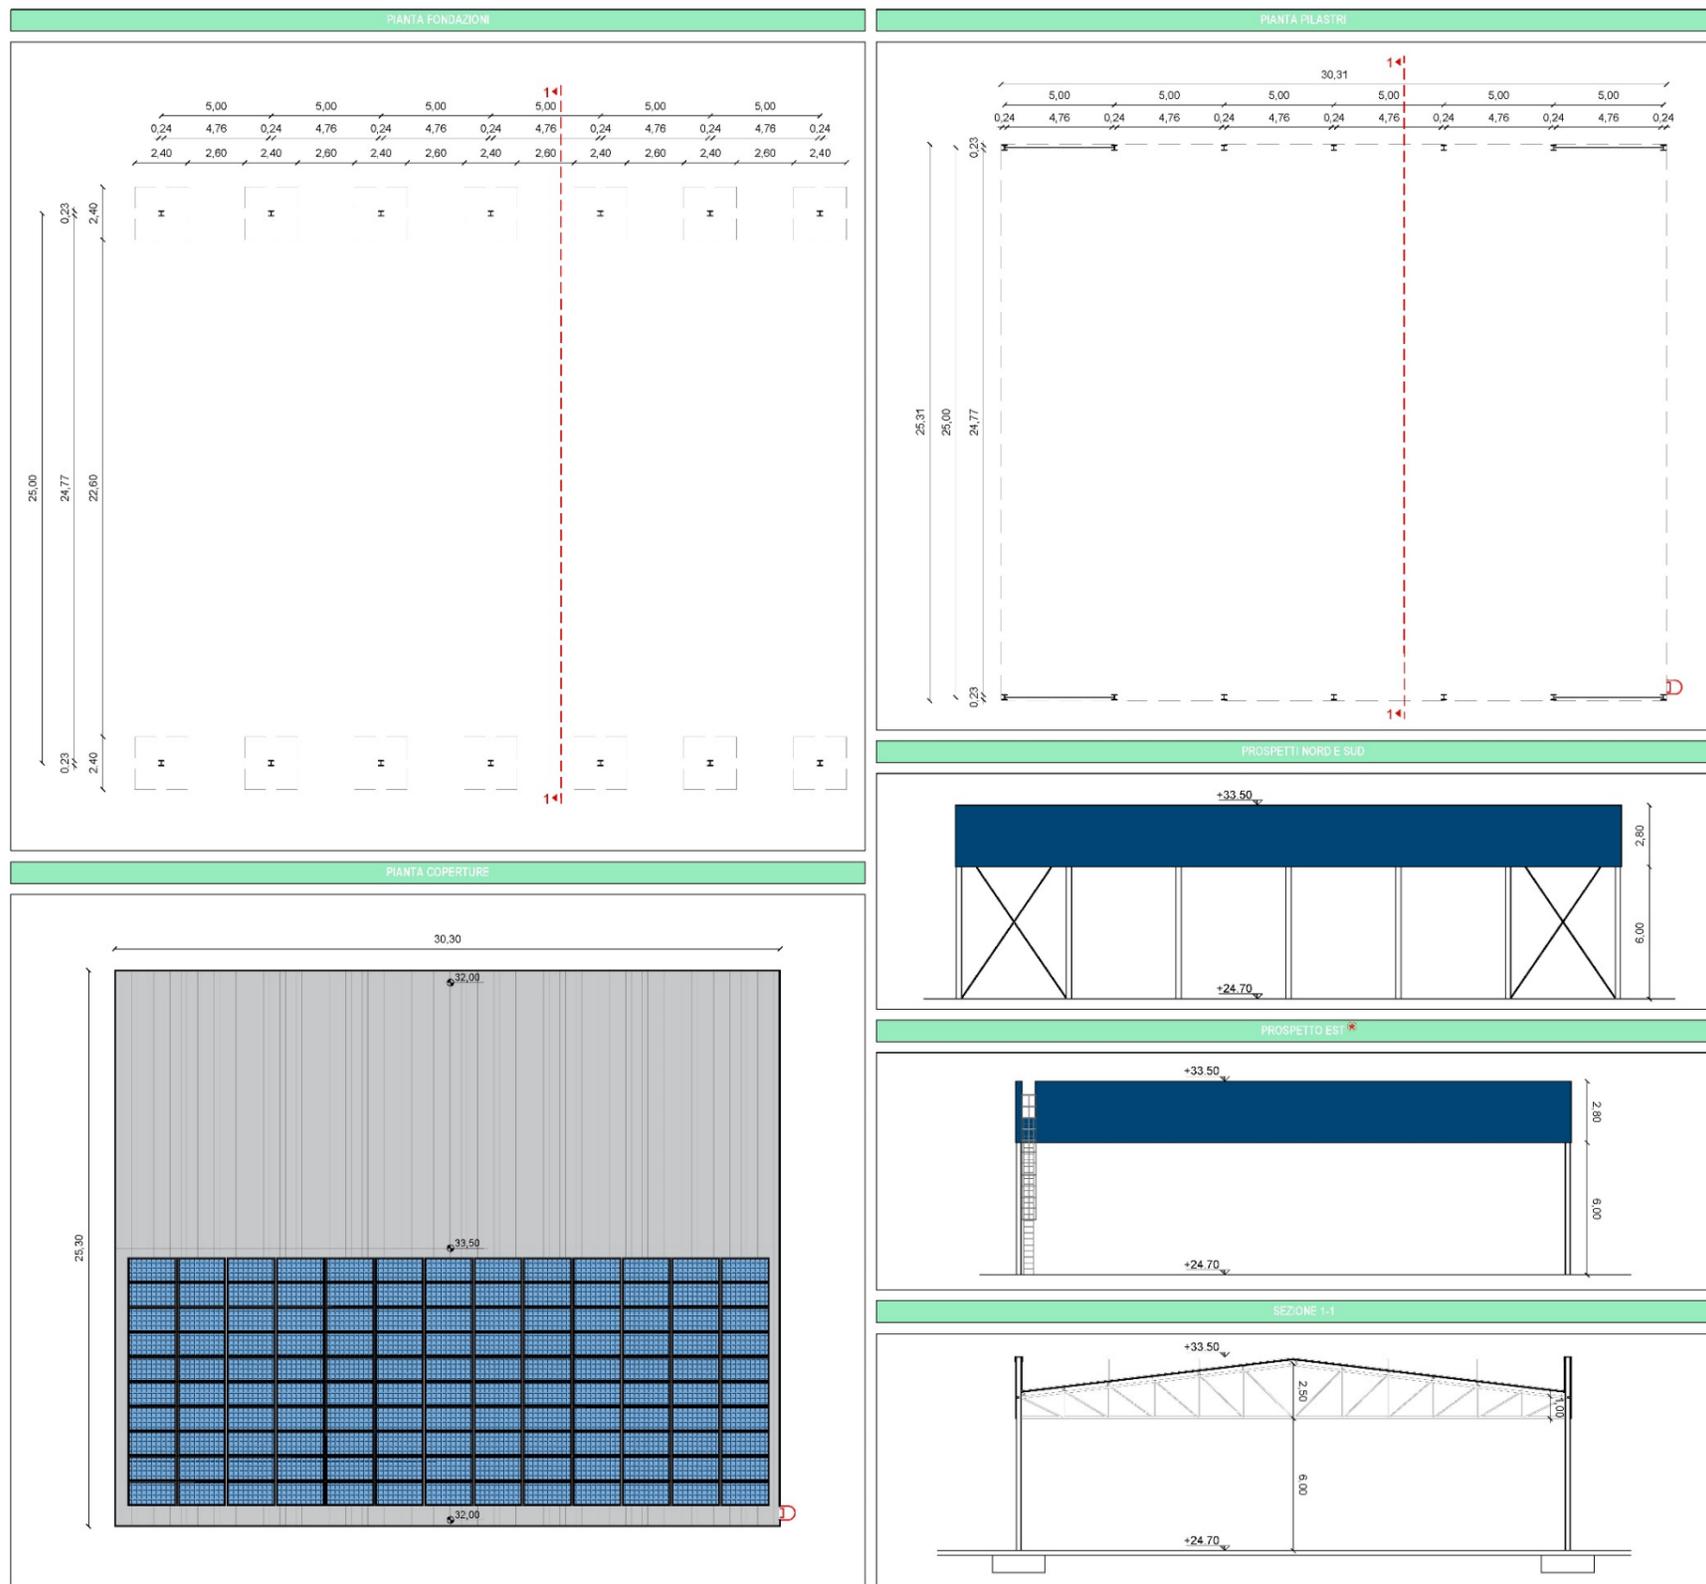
Tettoia amianto: Pianta fondazioni, pilastri e solaio di copertura, prospetti e sezione
